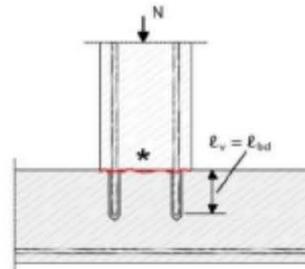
Chevauchement des joints dans la fondation d'une colonne ou d'un mur où les barres d'armature sont soumises à une tension.
